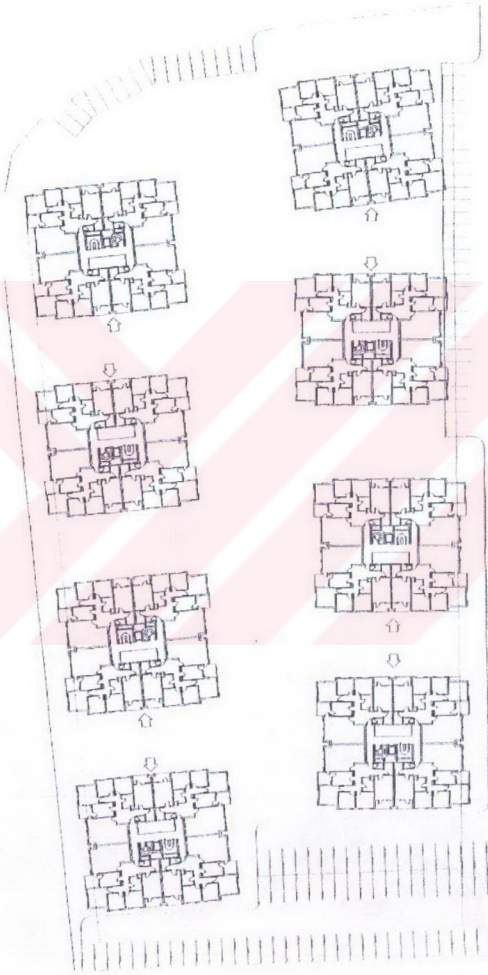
Yeni Barışkent C Tipi normal kat planı
